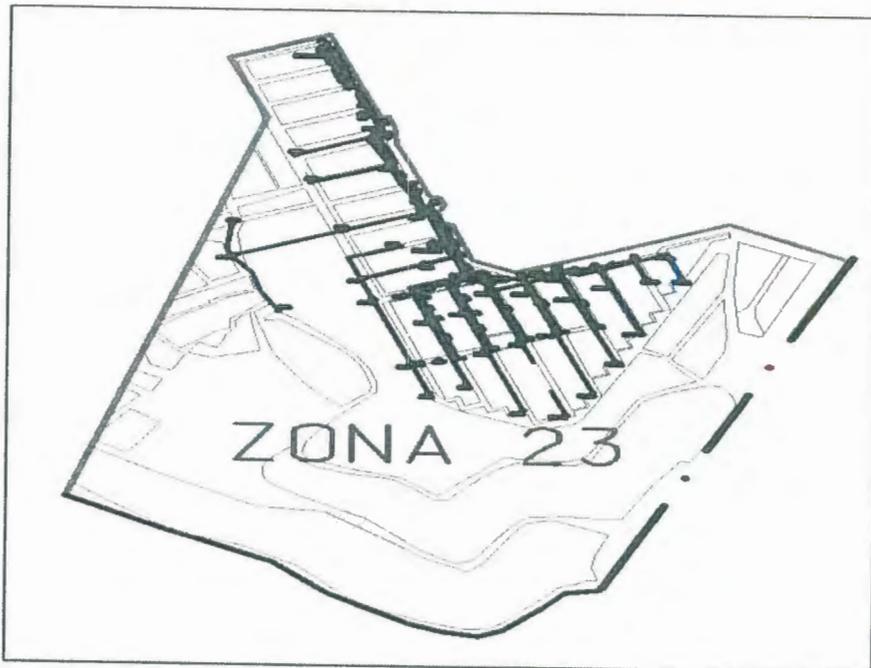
Planimetría zona 23 del sector de la vía a Daule
